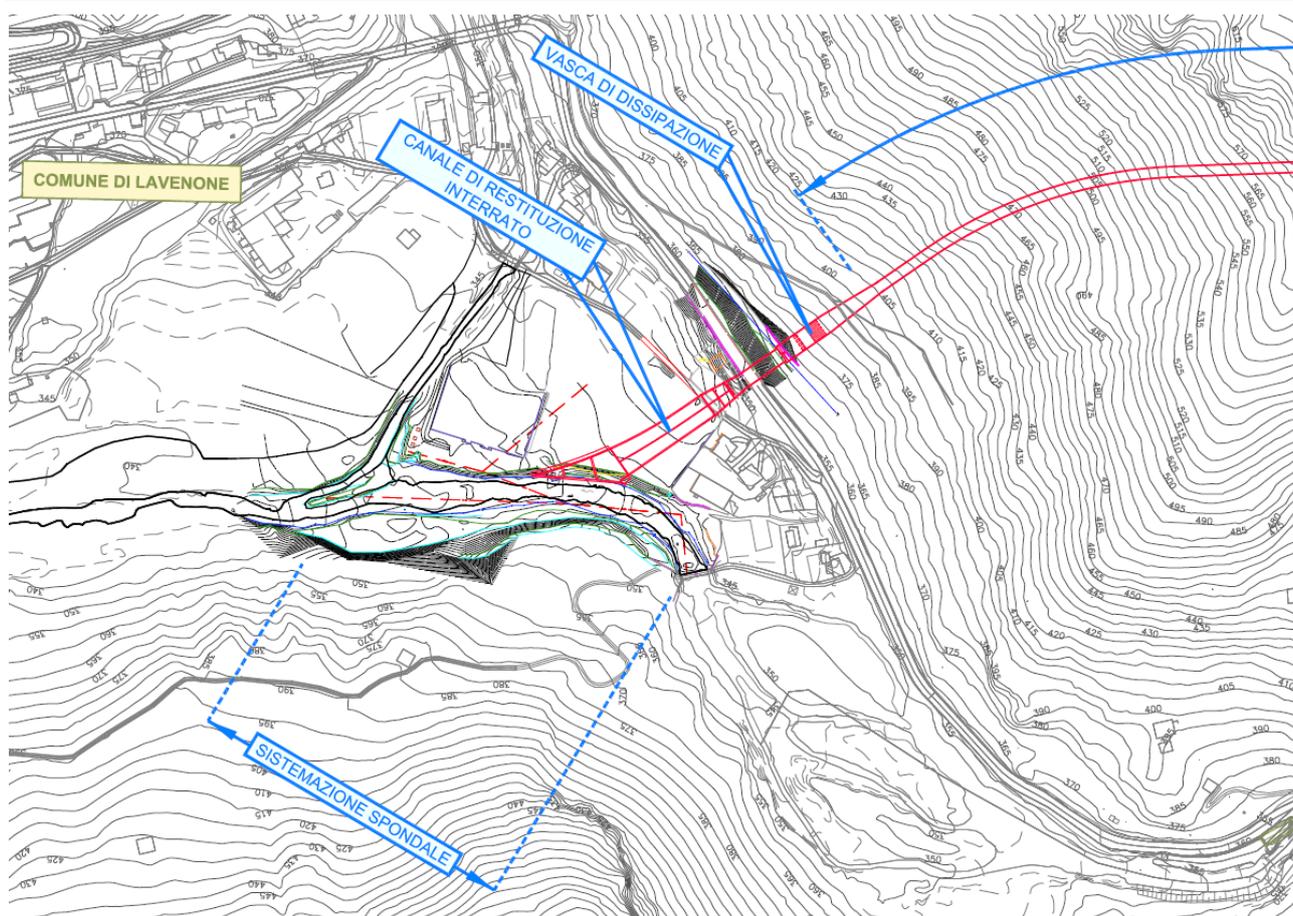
Localizzazione dell'area interessata dalla realizzazione del canale di restituzione, della vasca di dissipazione e la sponda oggetto di interventi di sistemazione spondale. Estratto della Tavola *planimetria generale degli interventi*.
